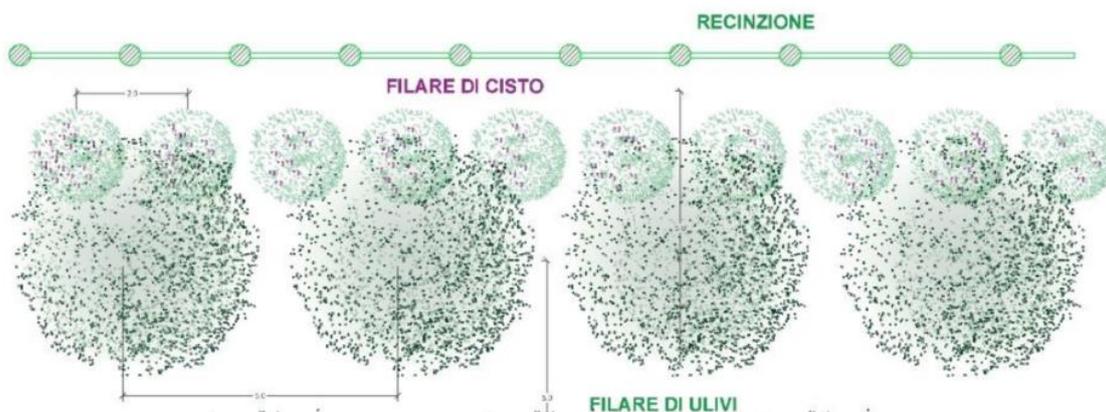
Rappresentazione fascia di mitigazione vista dall'alto
